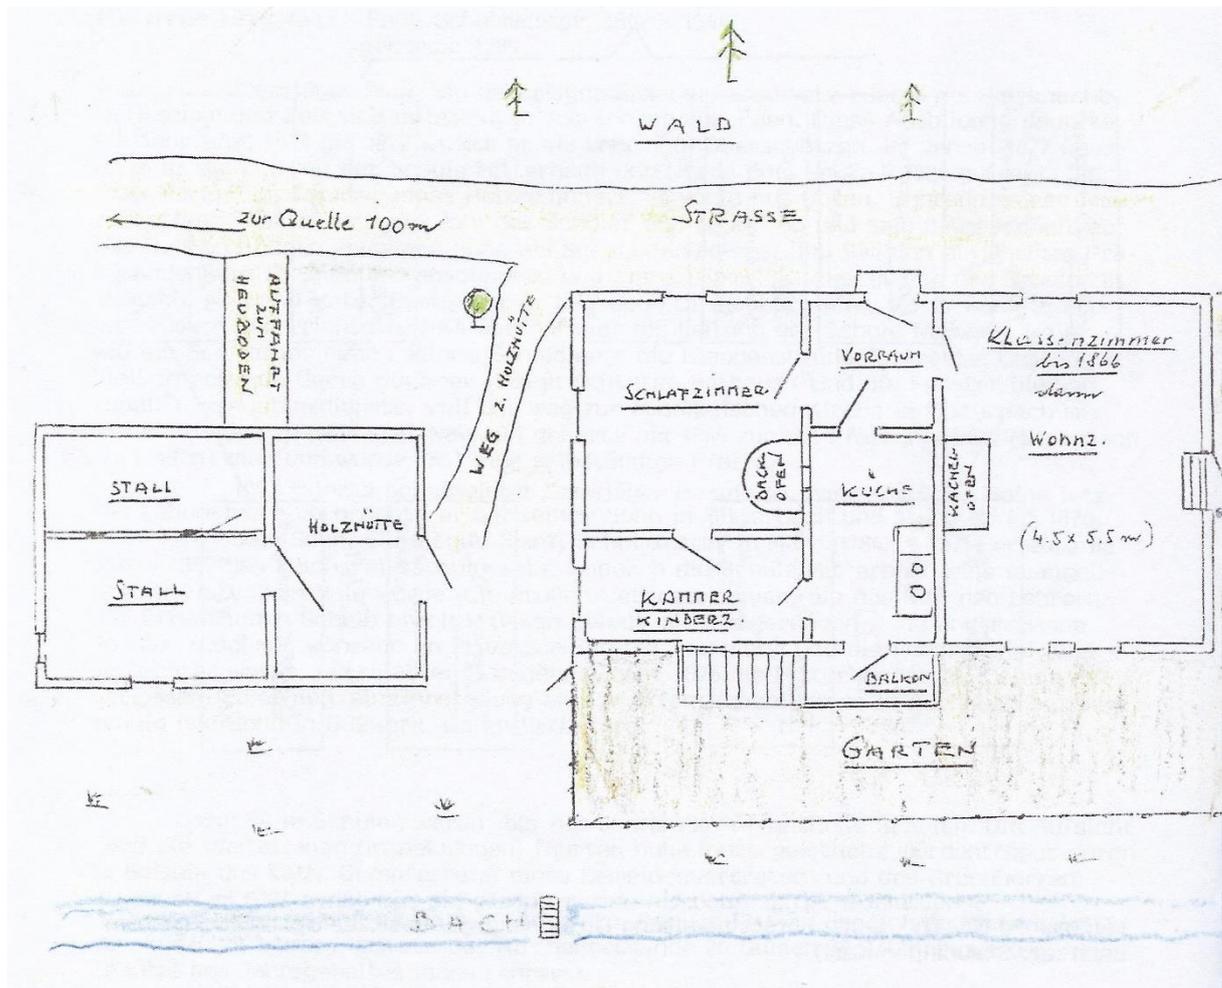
Grundriss der Schule (Mörtl & Kraft, 1986, S. 73)
